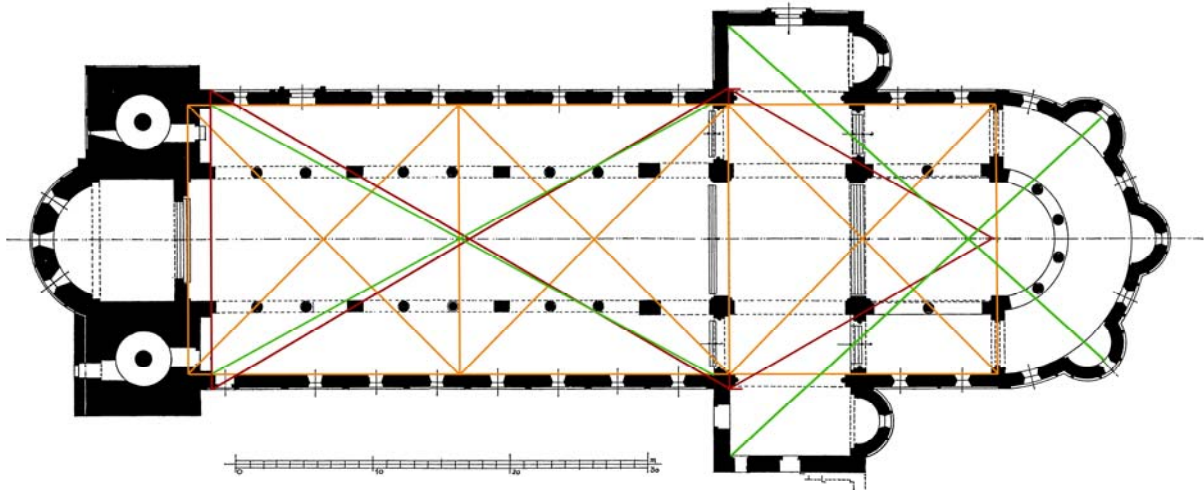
Hildesheim, Godehardikirche, Grundriss mit isogonalem Absteckdreieck (rot), Proportionsquadraten (gelb) und Weihekreuzen (grün). Grundlage: Inv. Hildesheim, Kirchliche Bauten (wie Anm. 18) Taf. 38.
